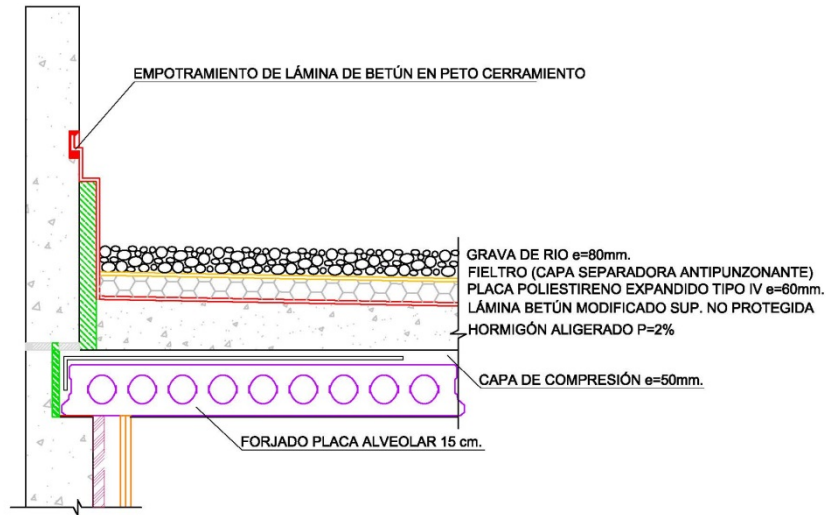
Detalle de la cubierta de la vivienda prefabricada
